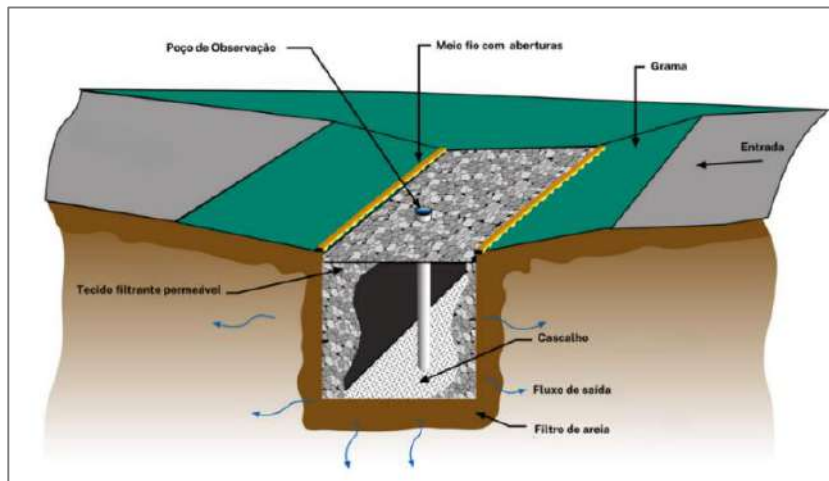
CONFIGURAÇÃO ESQUEMÁTICA DE UMA TRINCHEIRA DE INFILTRAÇÃO.
